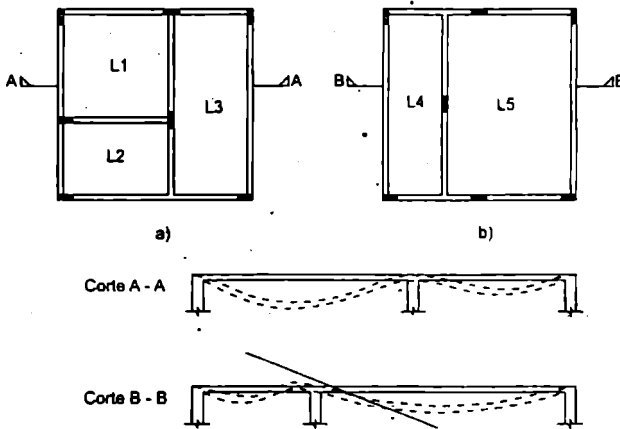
Lajes trabalhando em conjunto e rotação nos apoios.
